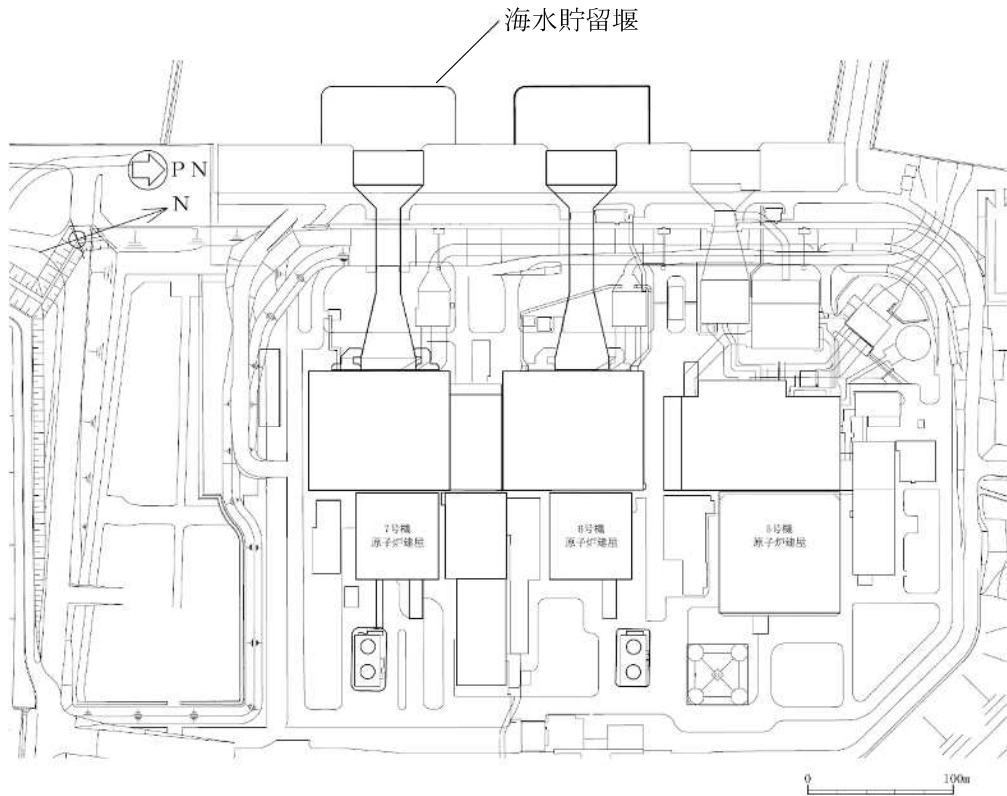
(1) 海水貯留堰の位置図 (全体平面図)
